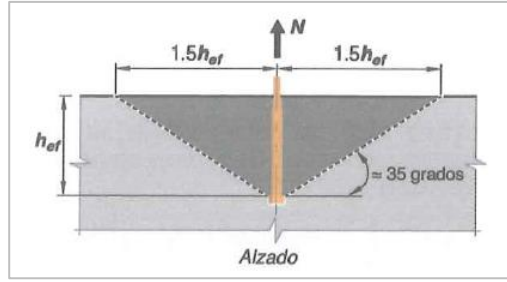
Cono arrancamiento por tracción del hormigón (ACI, 2019)
